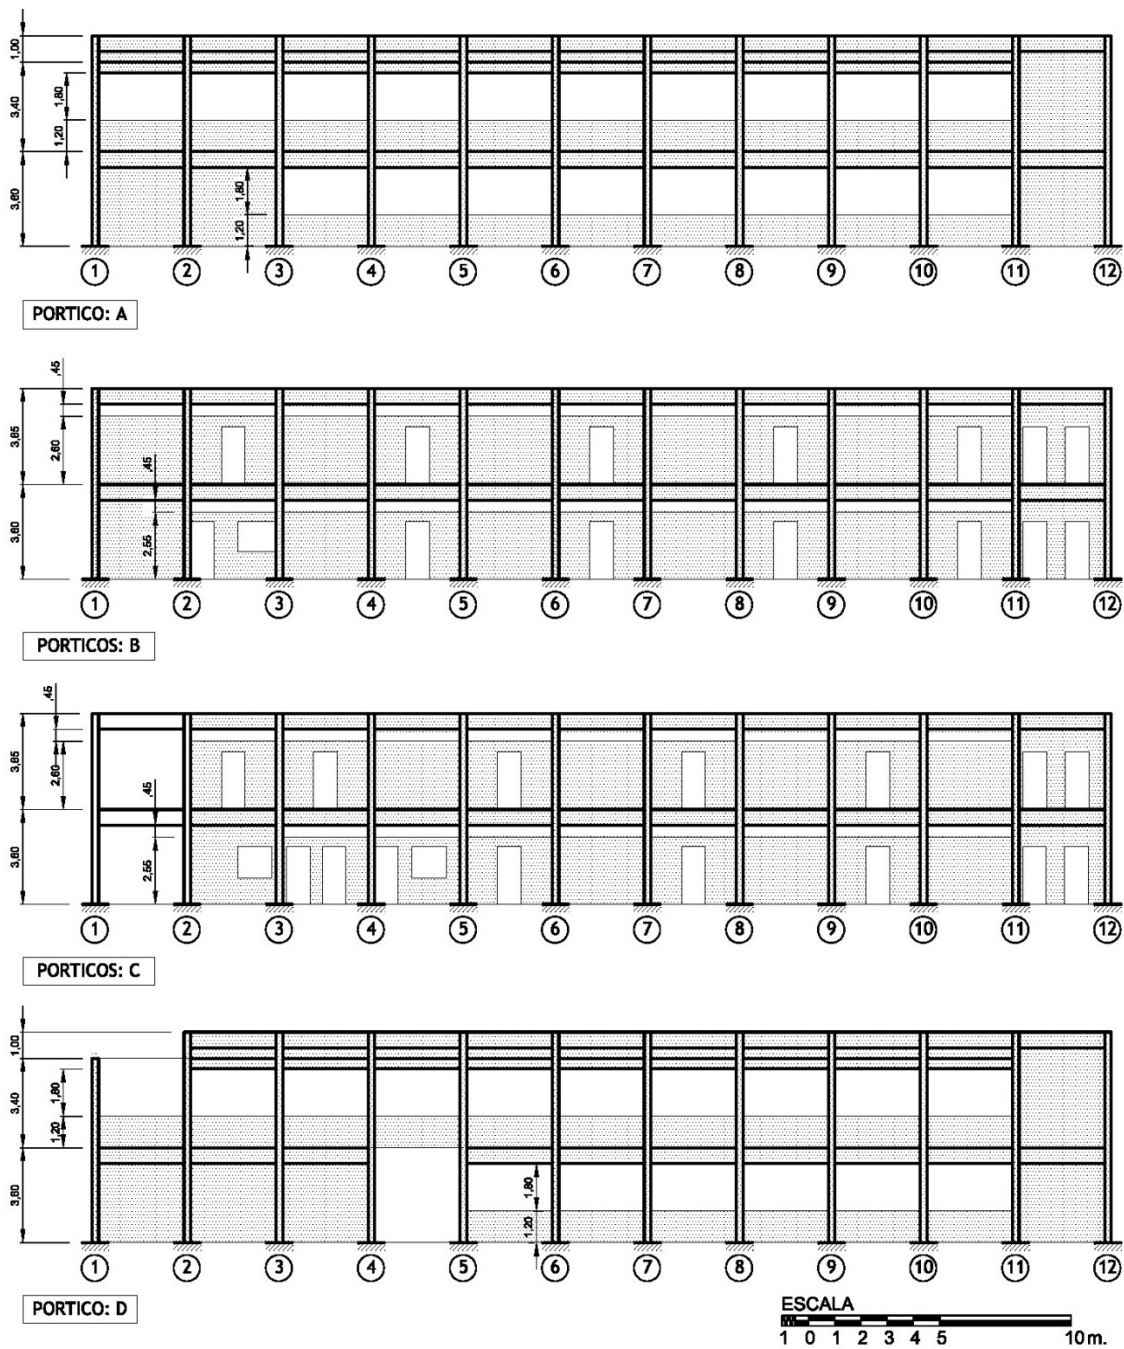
Pórticos longitudinales (Y) del Módulo Principal mostrando las paredes de mampostería y la longitud efectiva de las columnas.
